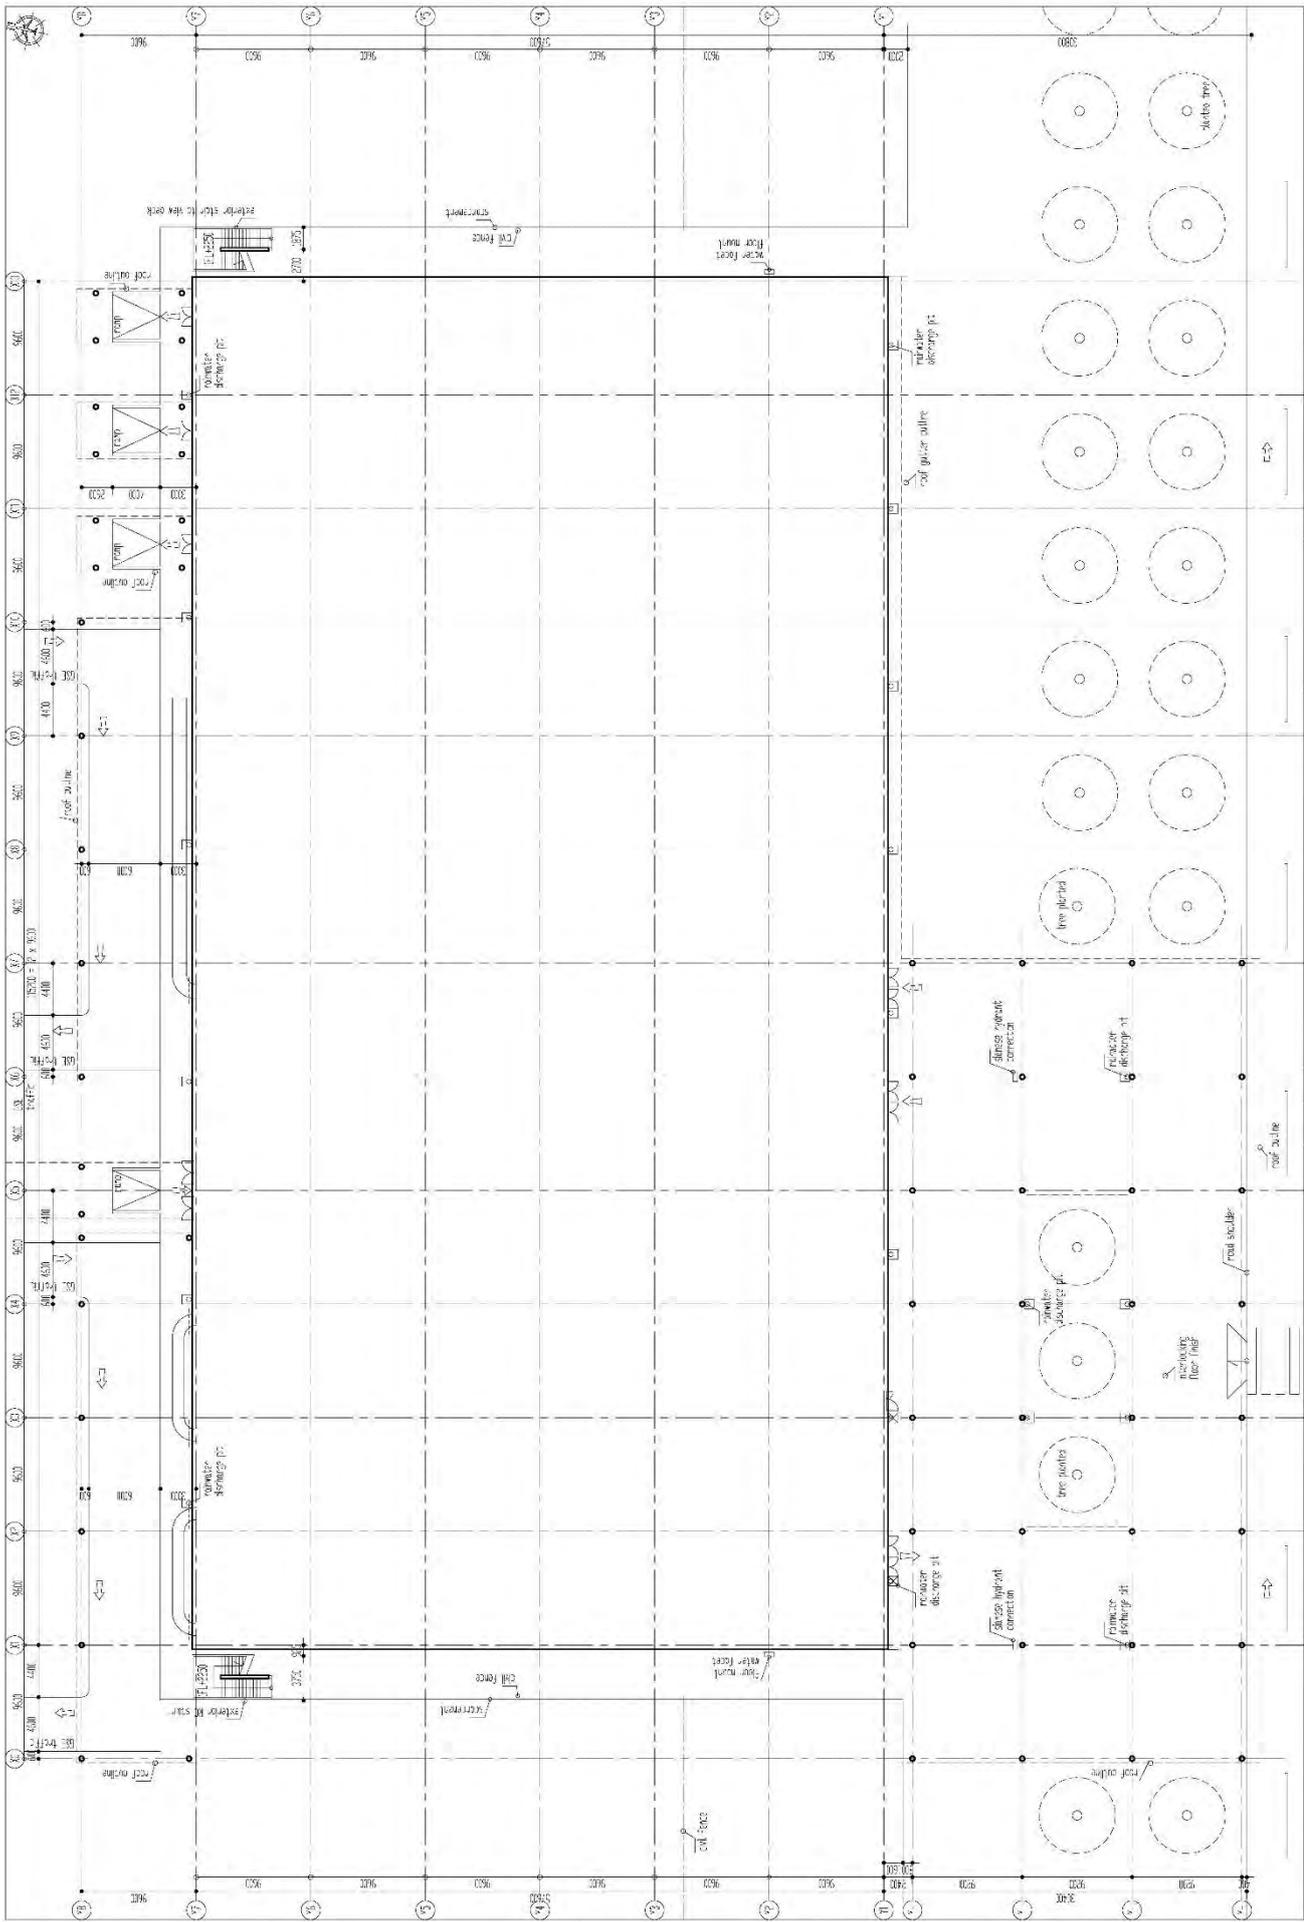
国際線旅客ターミナルビルサイト平面図
